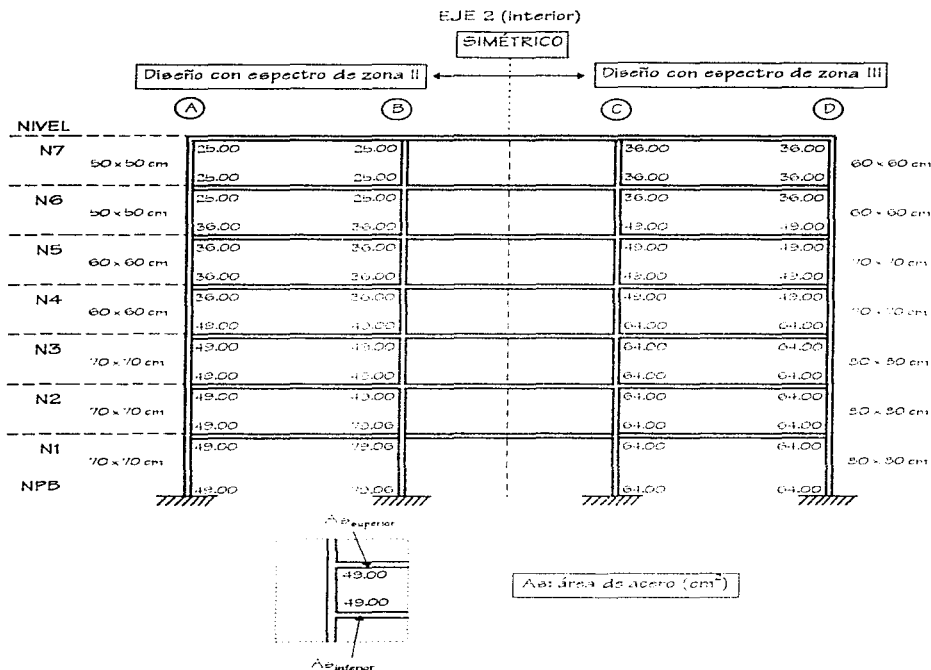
Comparación de cuantías de acero longitudinal de columnas de las estructuras diseñadas en zonas II y III
